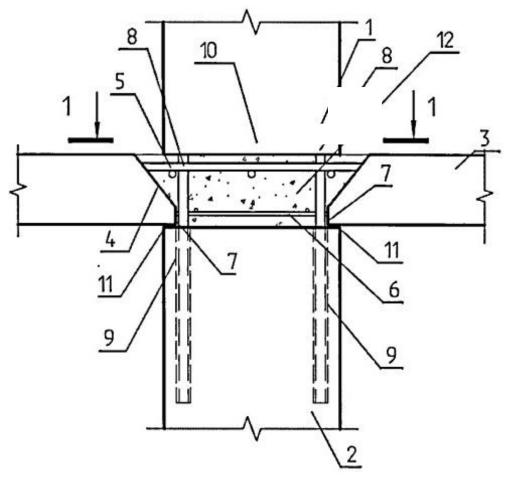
Конструктивный узел соединения колонны и плиты перекрытия
